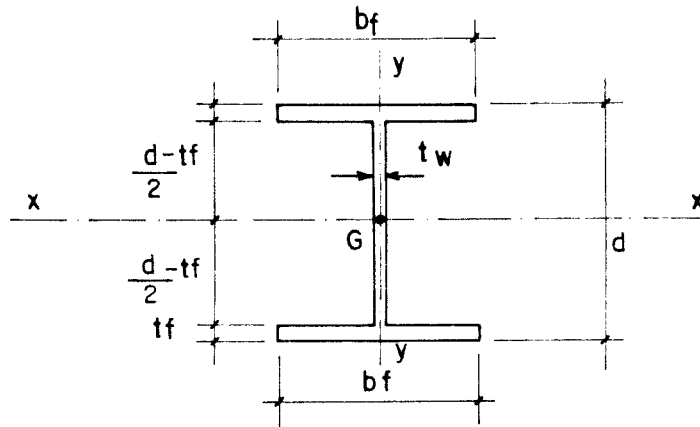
Perfil Soldado com Dois Eixos de Simetria
